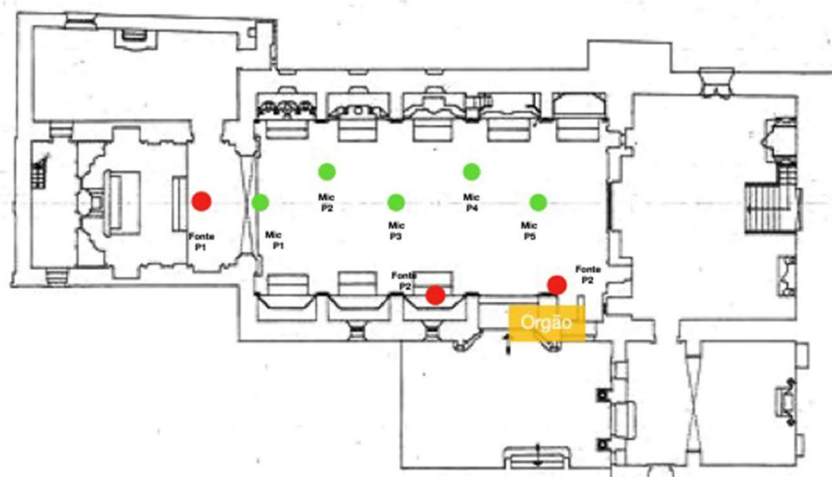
Planta da Igreja de Santa Clara com a identificação da posição da fonte sonora e aparelho de medição.
